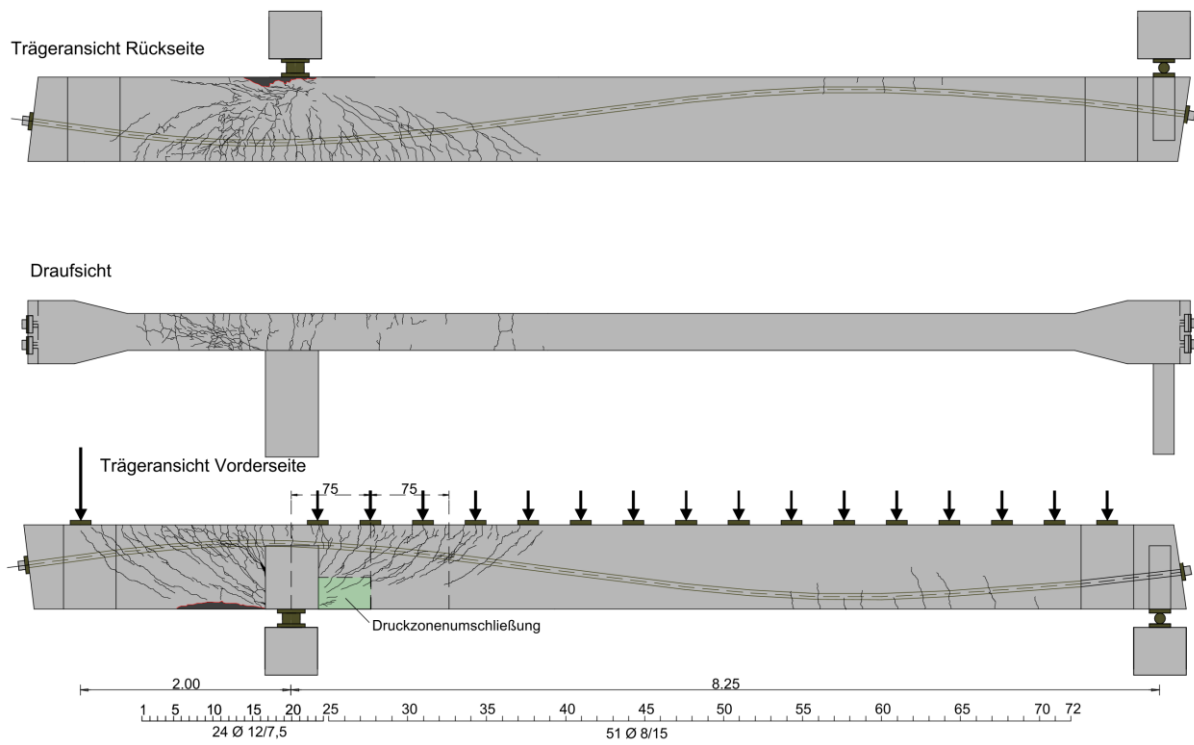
ETK5 Rissbilder unter Bruchlast
